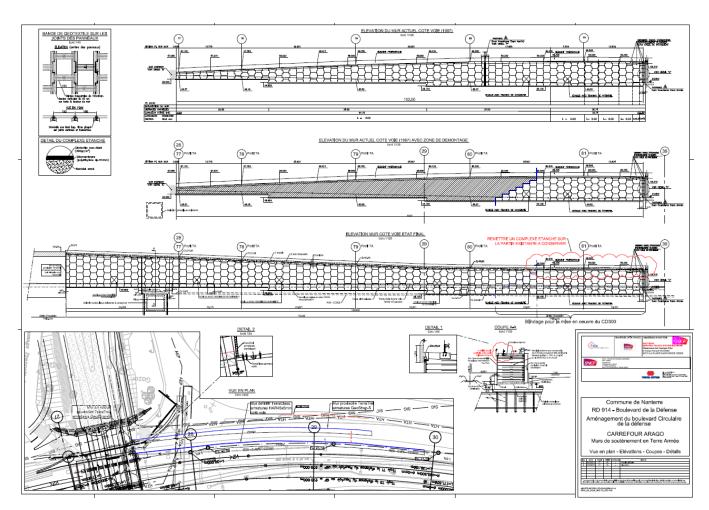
Murs de soutènement en terre armée : vues en plans - élévations – coupes – détails
